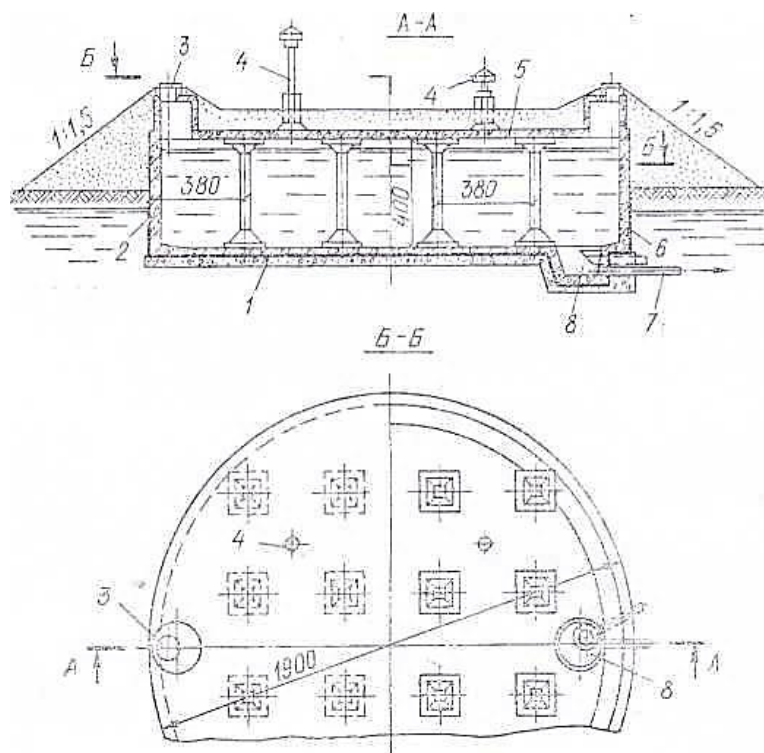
Железобетонный резервуар объемом 1000 м^3 , выполняемый в мокрых грунтах
